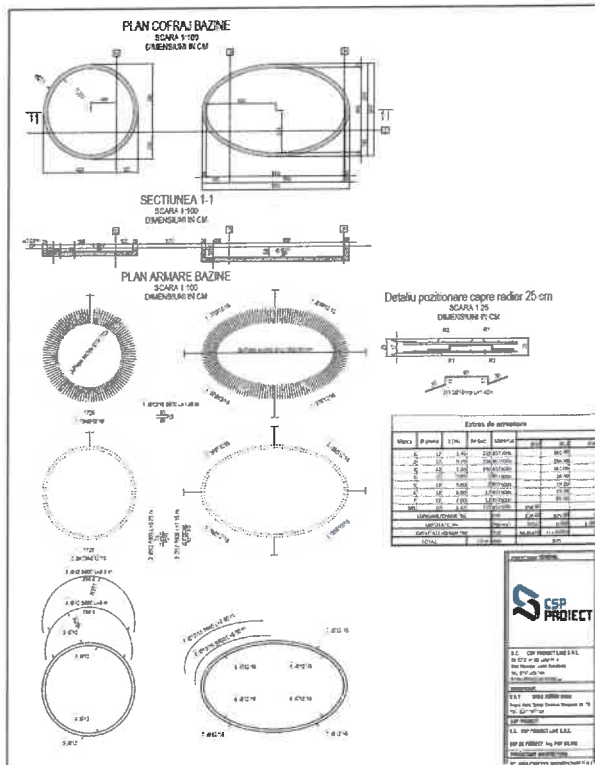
Plan cofraj si armare bazine secundare, corp C2
